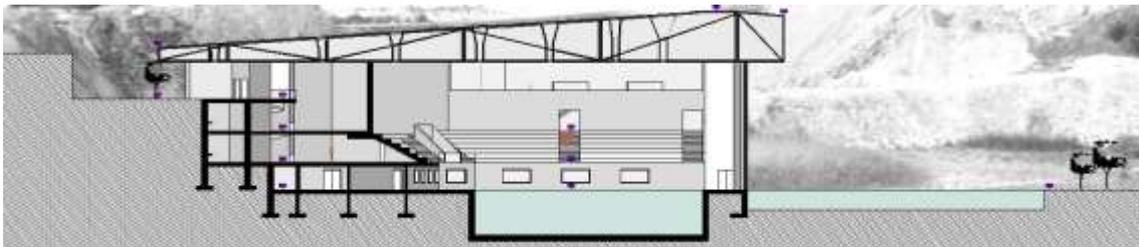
Secção DD, rasgos e estrutura metálica da cobertura.
